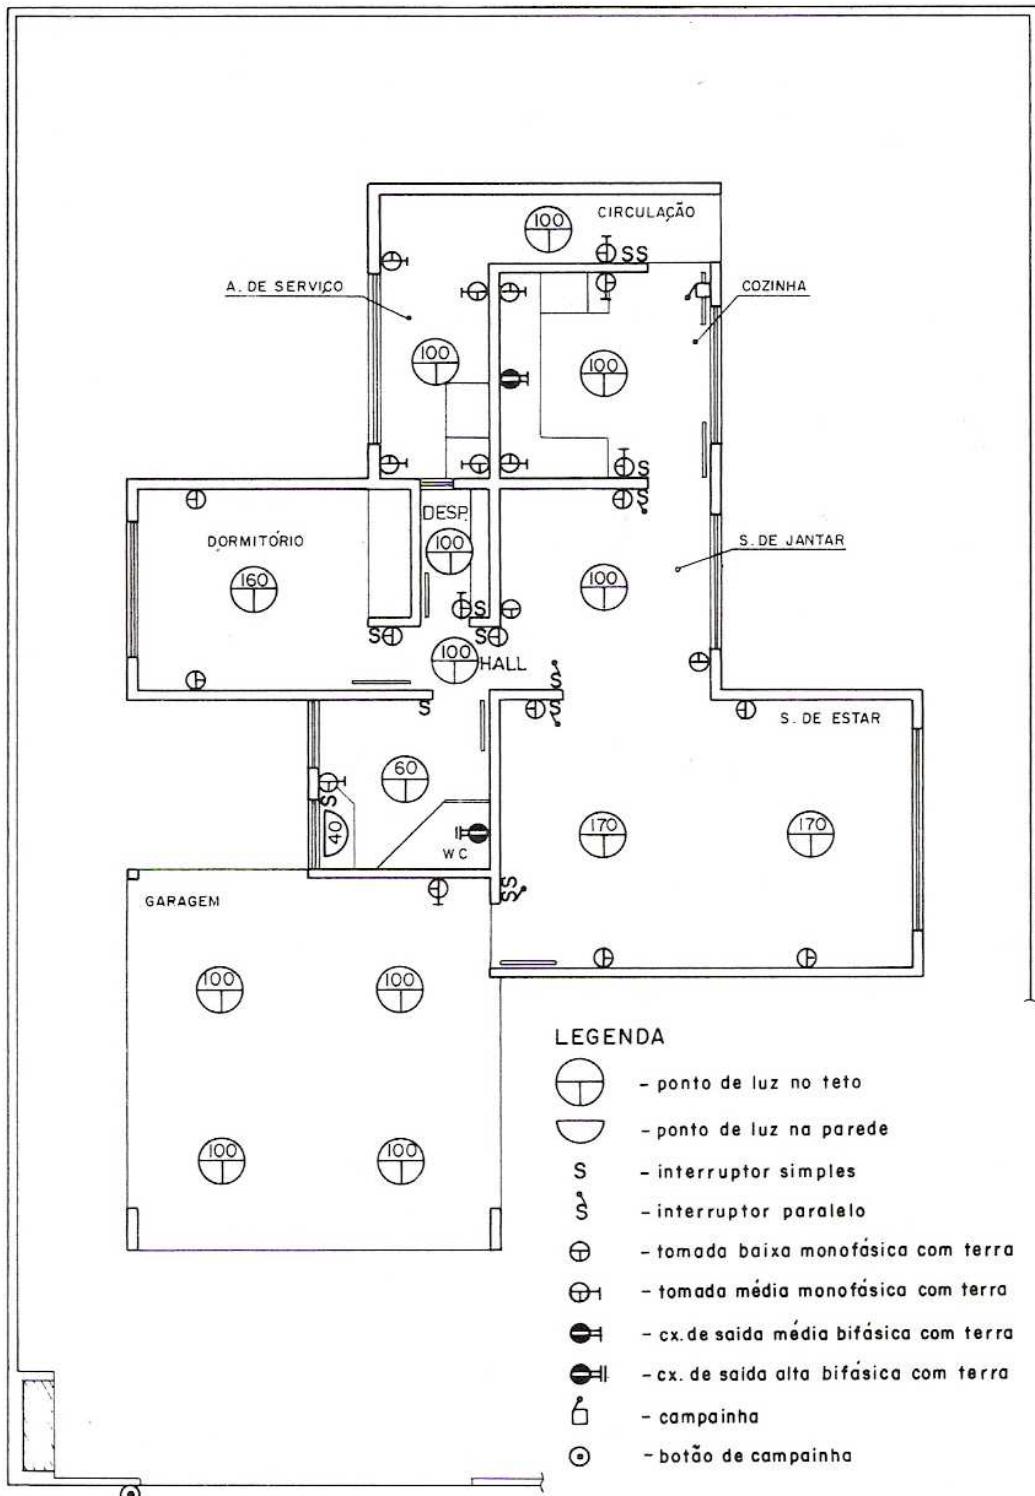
Planta baixa do exemplo com a locação dos pontos elétricos
